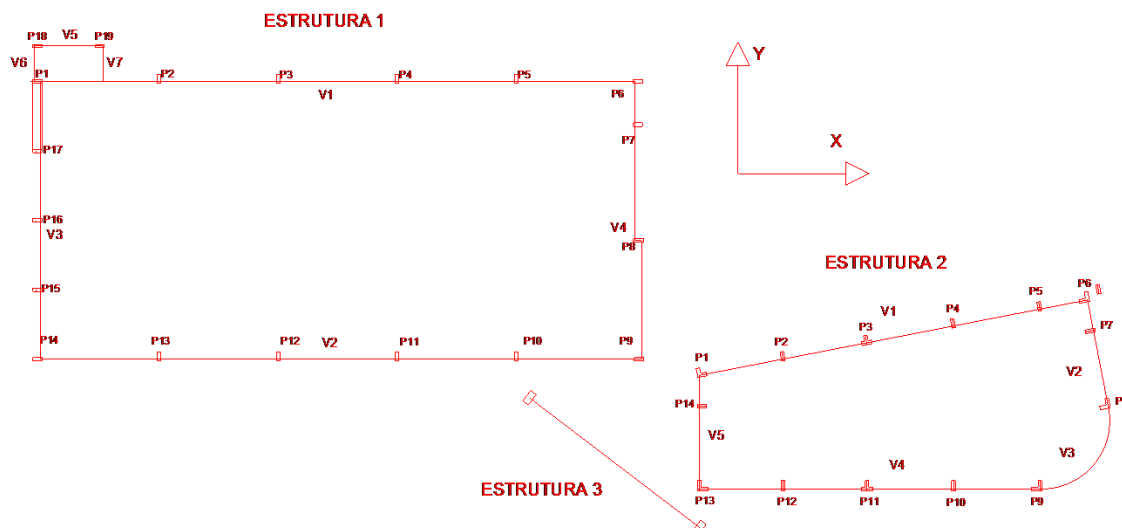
Croqui em planta da estrutura, sem alvenaria
